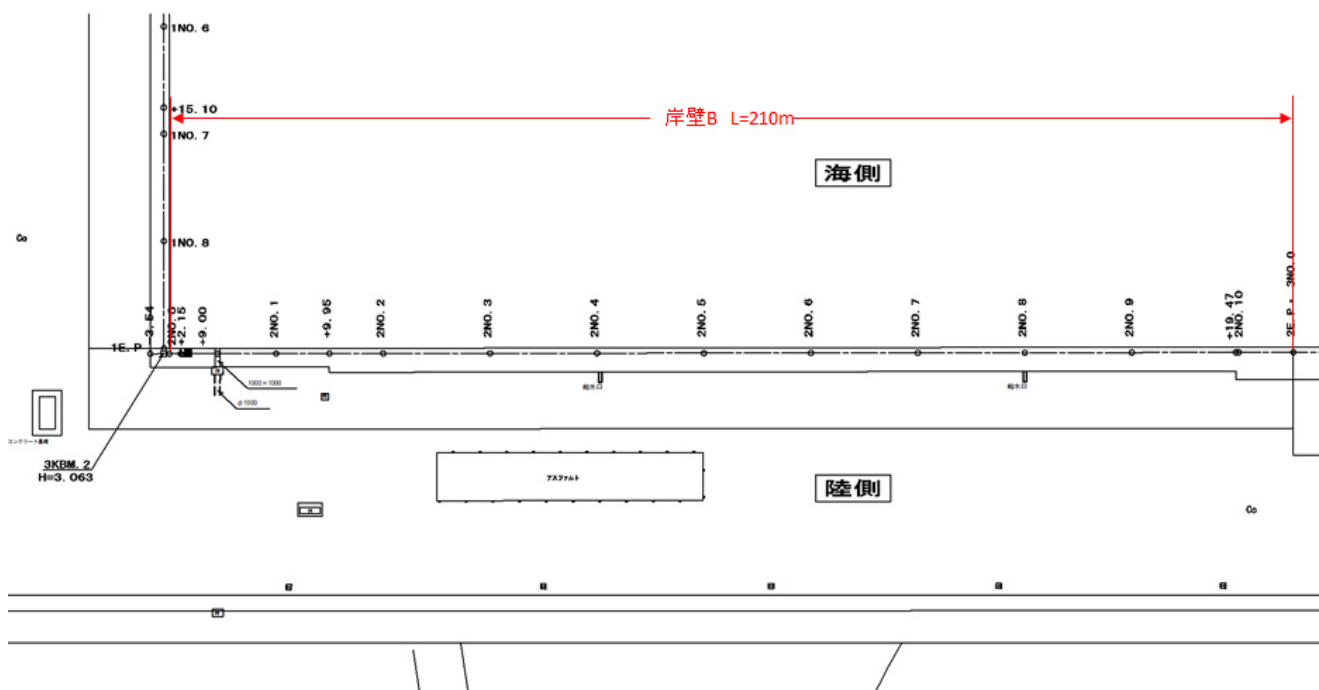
244 No.22 常陸那珂港区\_南埠頭地区 B 岸壁 (-5.5m) の平面図 (被災前)
